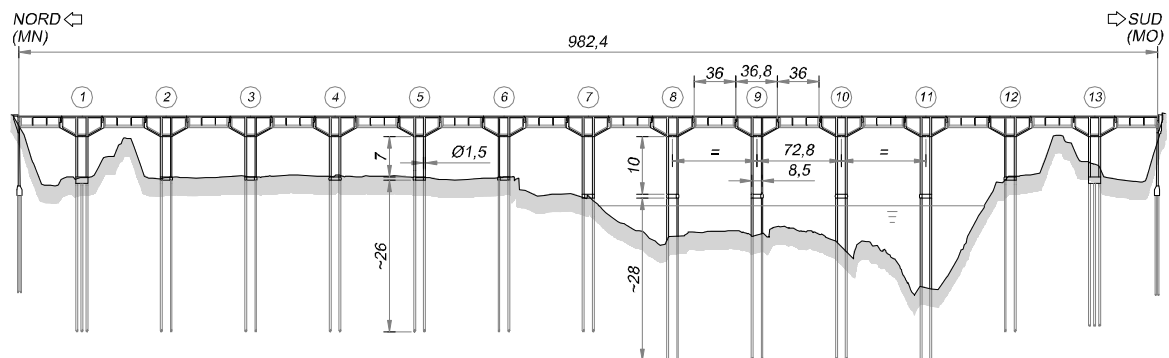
Profilo longitudinale dell'opera, quote batimetriche rilevate nel 2009 -
